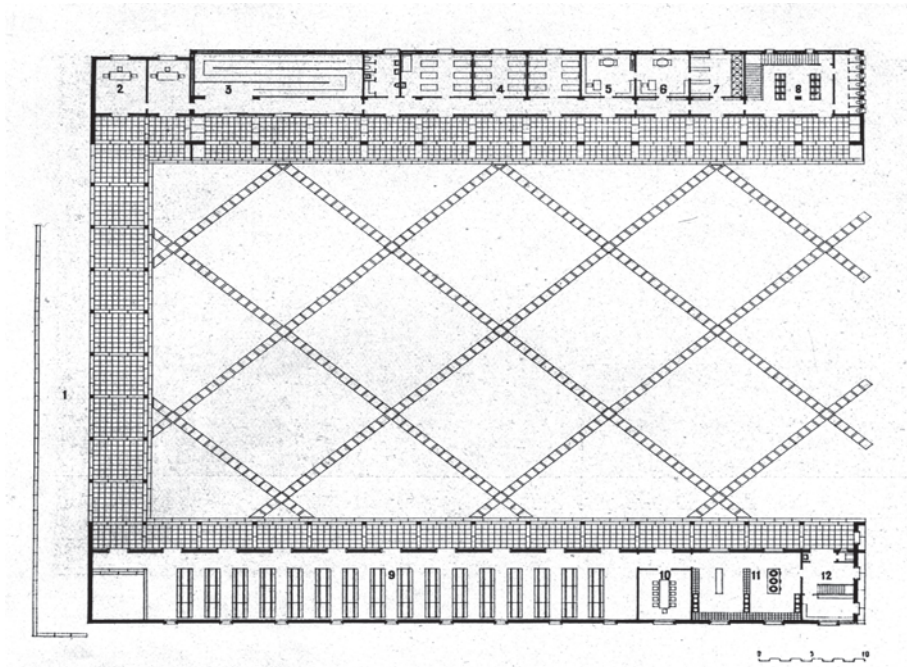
Ferienkolonie „Principe di Piemonte“: Grundriss EG
